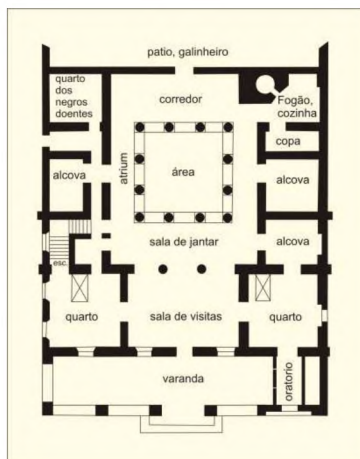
Planta de uma casa de chácara, desenhada por Debret
